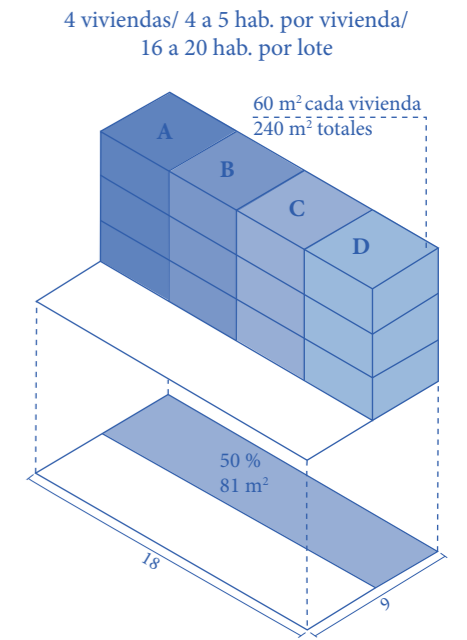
Cabida potencial de viviendas Densificación de lote 9x18 Fuente: Laboratorio 9x18
